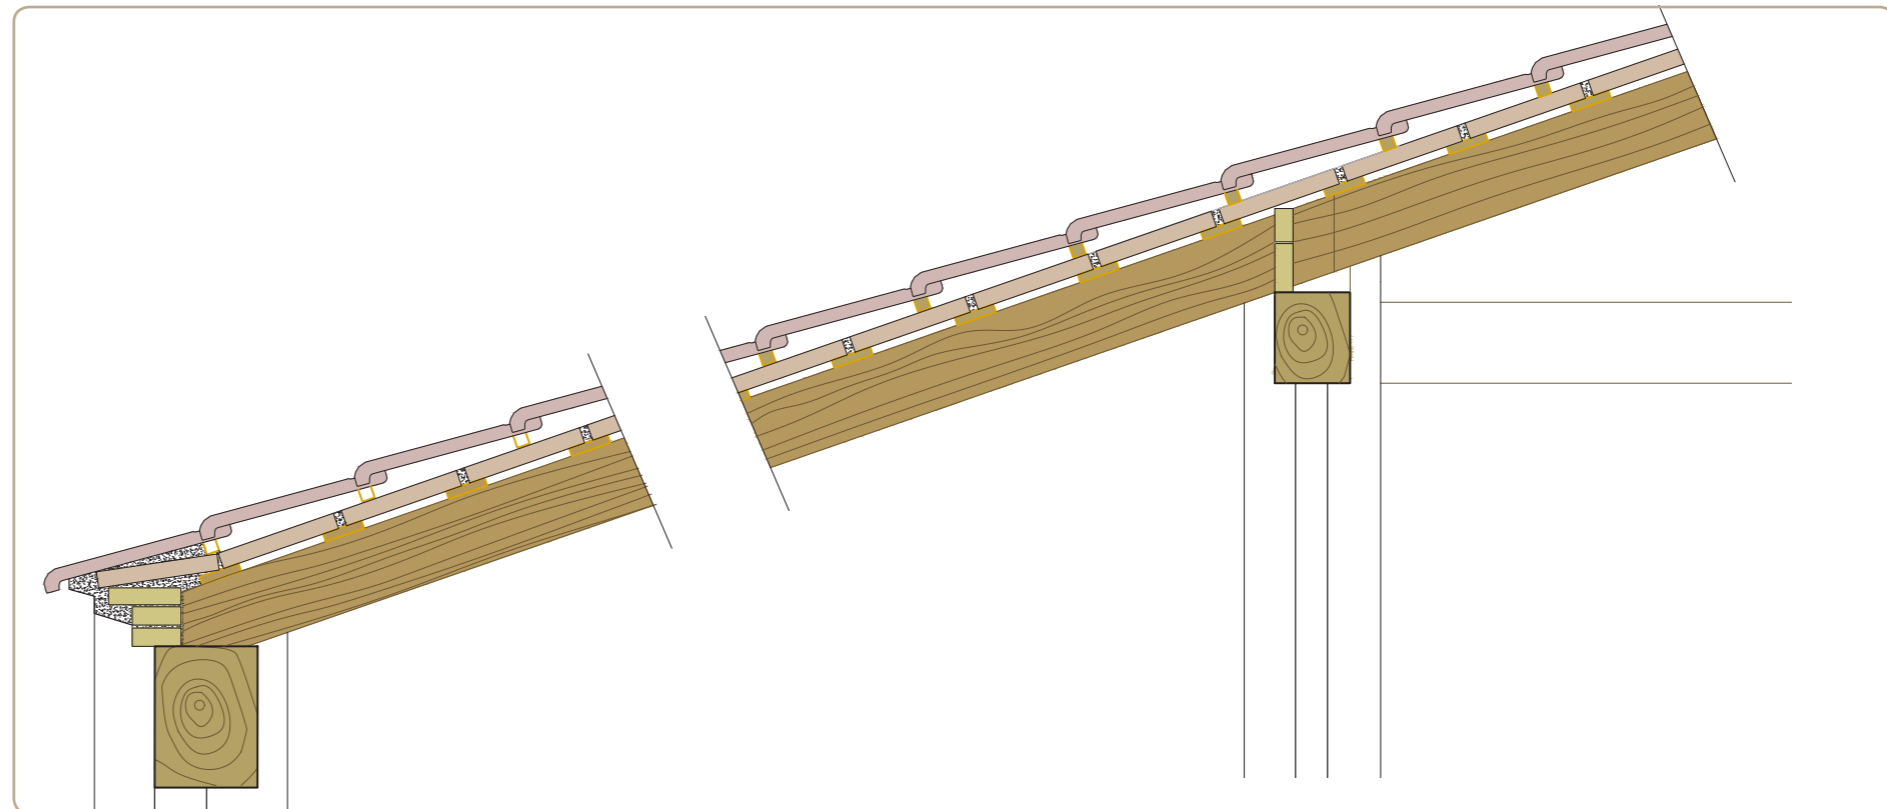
(Izquierda) Detalle encuentro inferior de cubierta a un agua sobre viga de madera empotrada en pilares.
